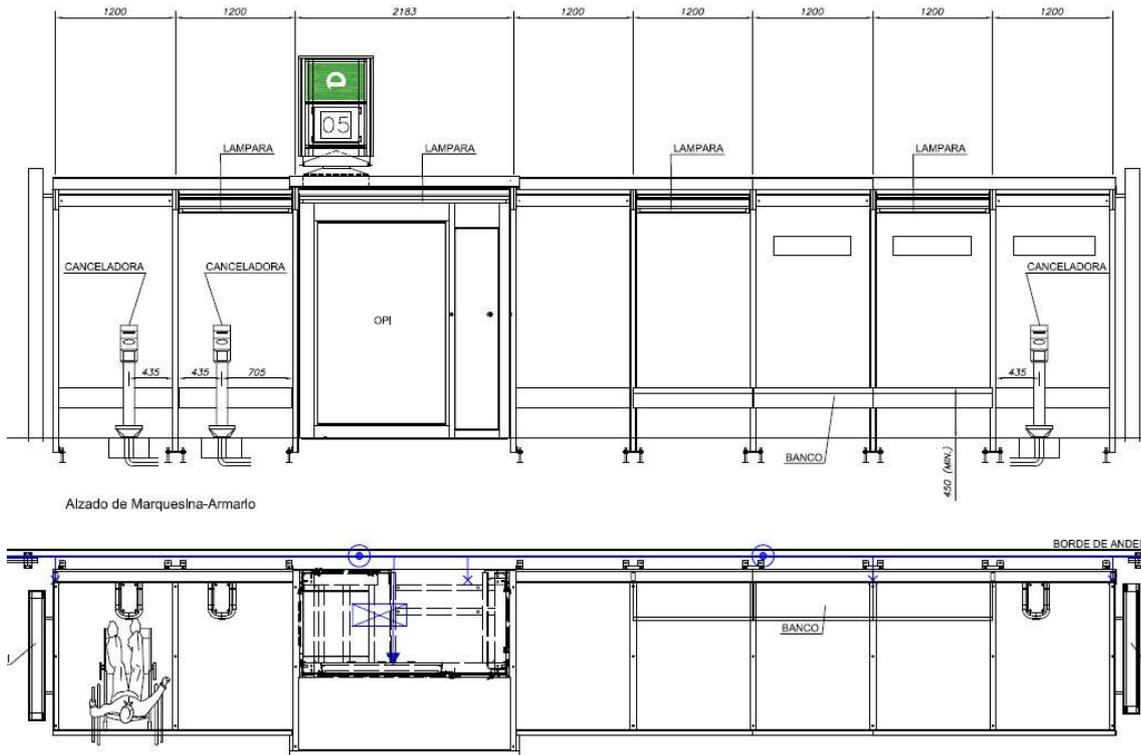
Planta y alzado de marquesina de parada tranviaria con andén lateral
